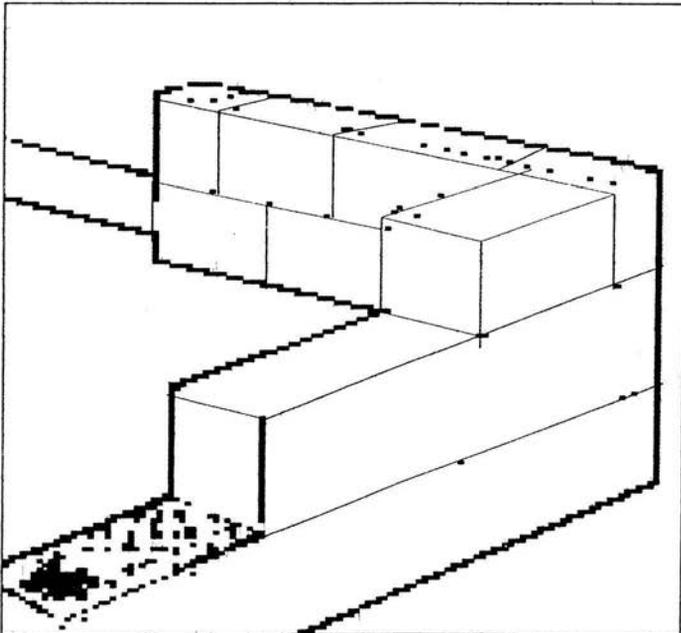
En la figura se ilustra la aplicación de membrana asfáltica en la primer hilada de bloques de concreto celular, esta protección puede ser del tipo asfalto oxidado o laminas impermeabilizantes de asfalto.
